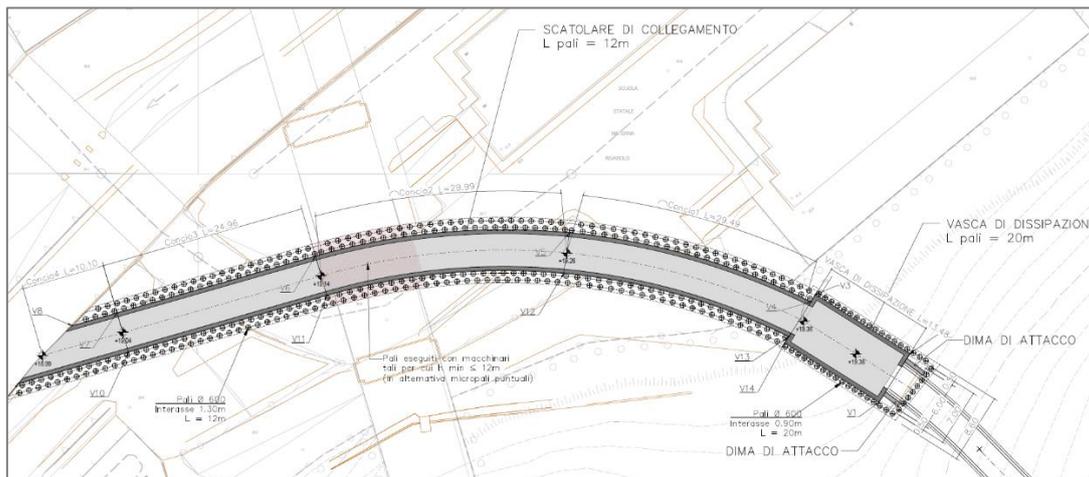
Planimetria generale di progetto dello scotolare di collegamento (rif. elaborato II151F-PD-STR-D040\_1)
